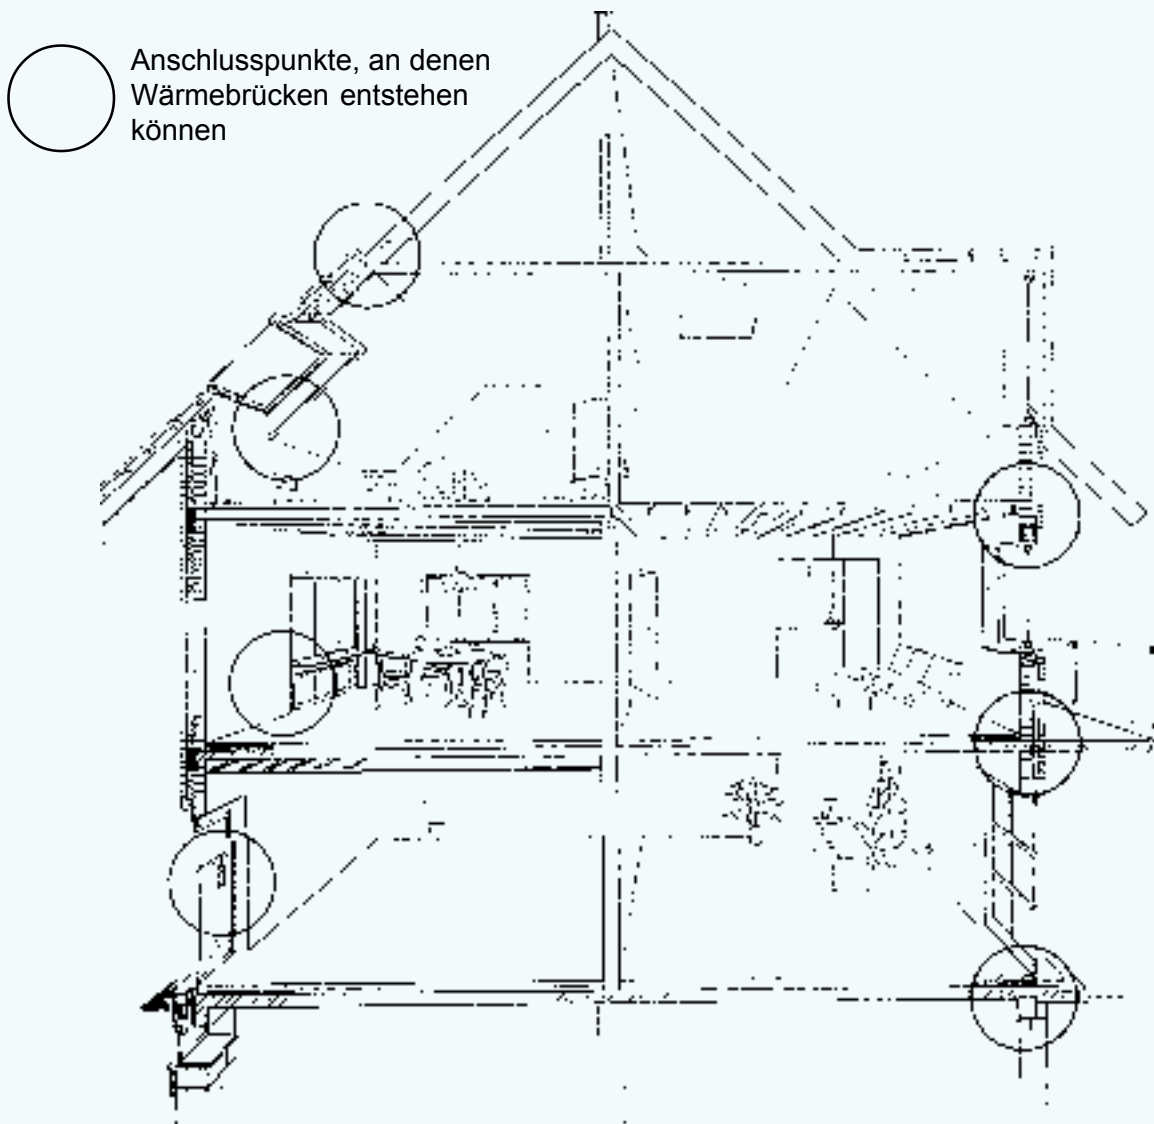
Gebäudeschnitt mit typischen Wärmebrücken
